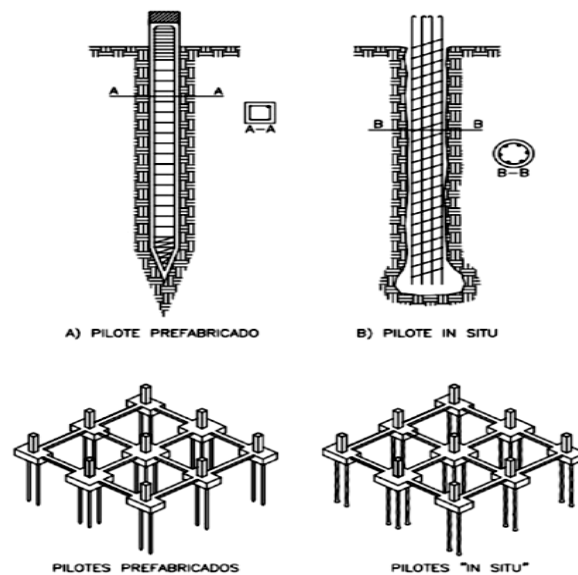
Ejemplos de cimentación a base de pilotes (Tomado de A. Couto Yáñez, M. Guaita Fernández, M. J. López Villar).
